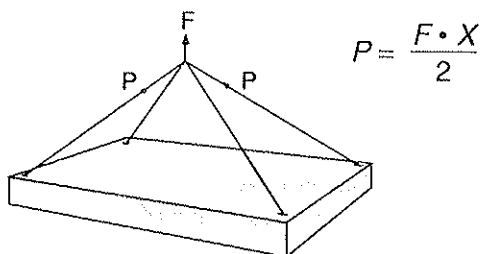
Avståndet mellan infästning för olika spridningsvinklar.
